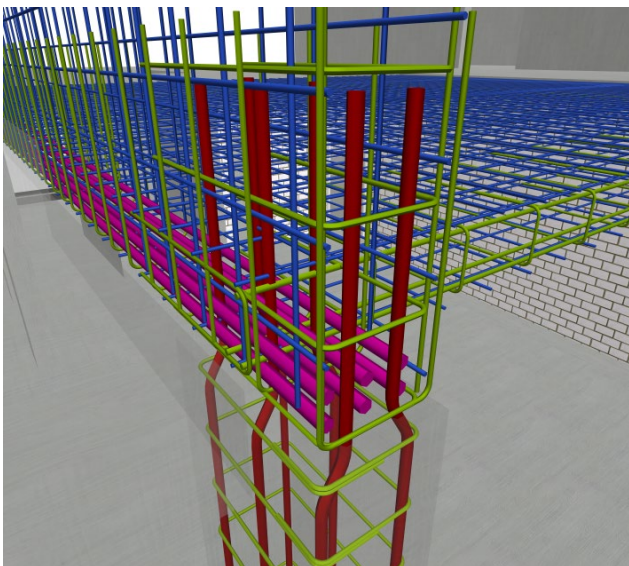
Planung der Bewehrung - 3D-Modell in ViCADo
